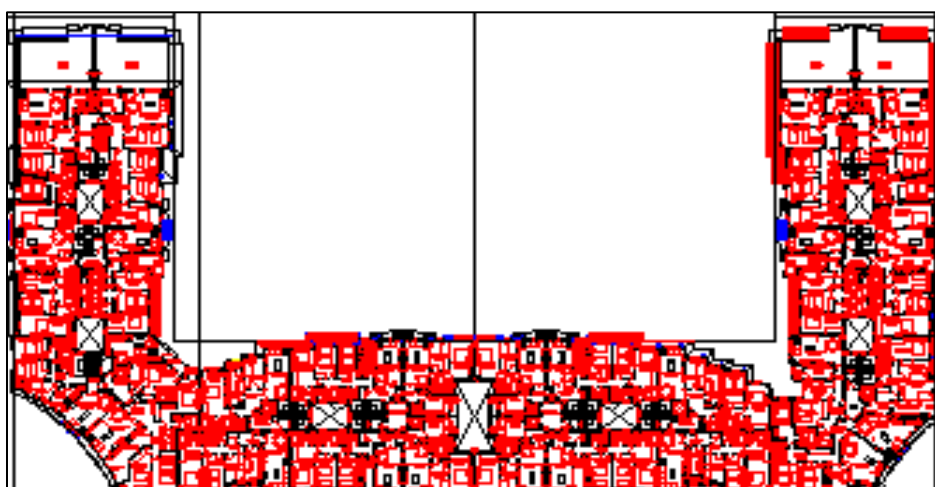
Vista en planta de la planta 6ª. Fuente: Departamento de Ingeniería Térmica y de Fluidos, Universidad Carlos III de Madrid.
